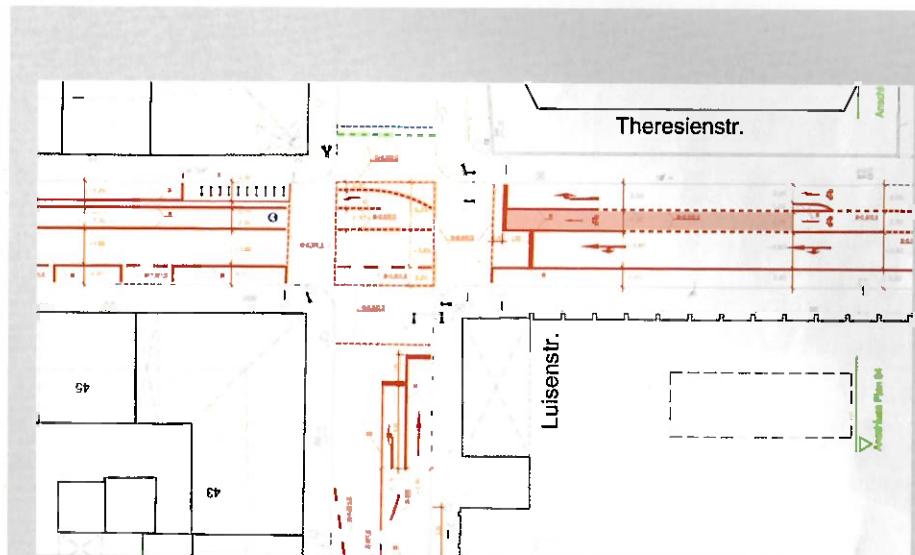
Ausschnitt aus dem Markierungsplan des Radfahrstreifens am Knotenpunkt Luisen-/Theresienstraße (Mobilitätsausschuss 2021b)
